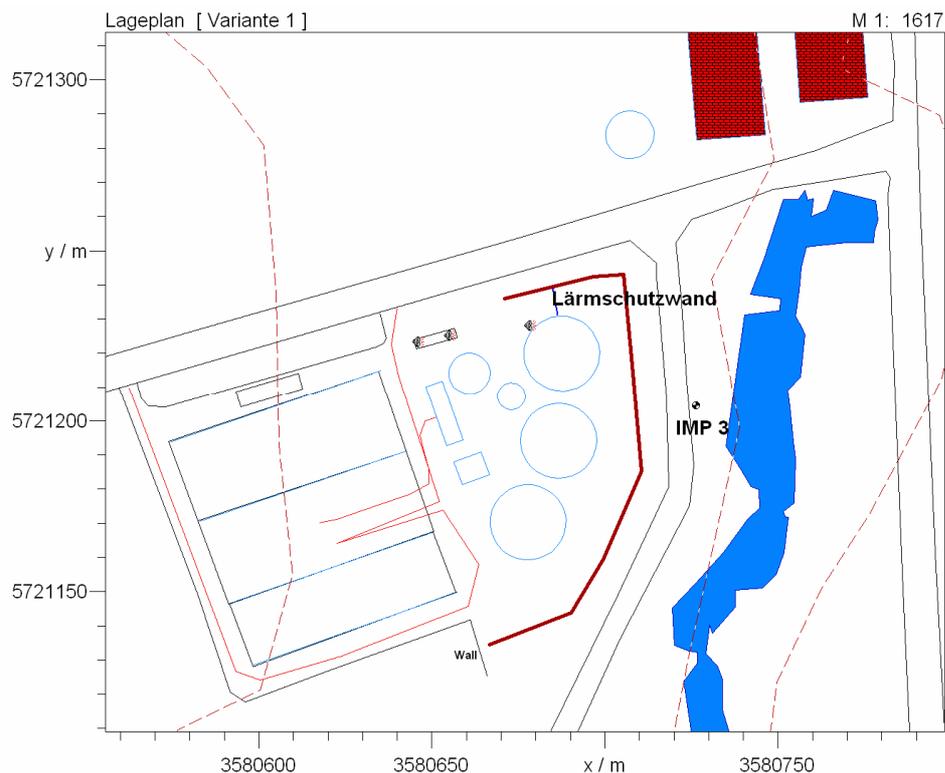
Lage einer erforderlichen Lärmschutzwand (Höhe: 6,0 m)
